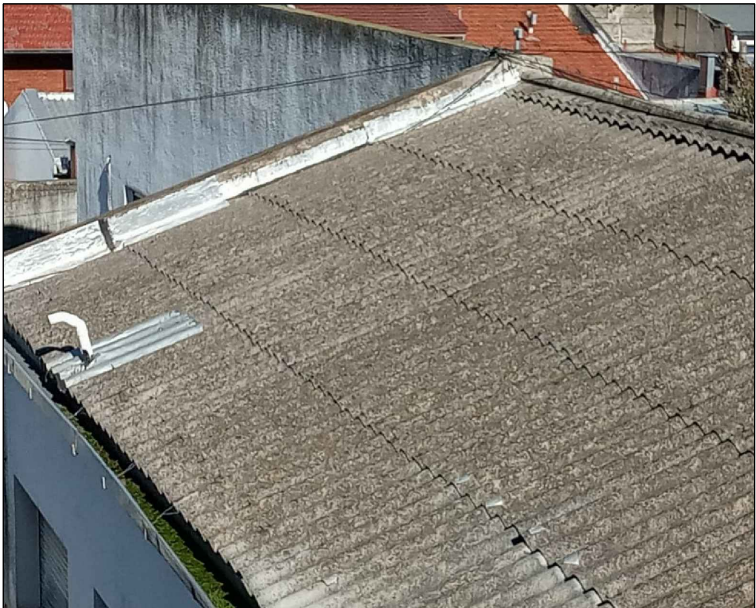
CUBIERTA ALA 2 SOBRE LABORATORIOS HACIA PATIO 3
